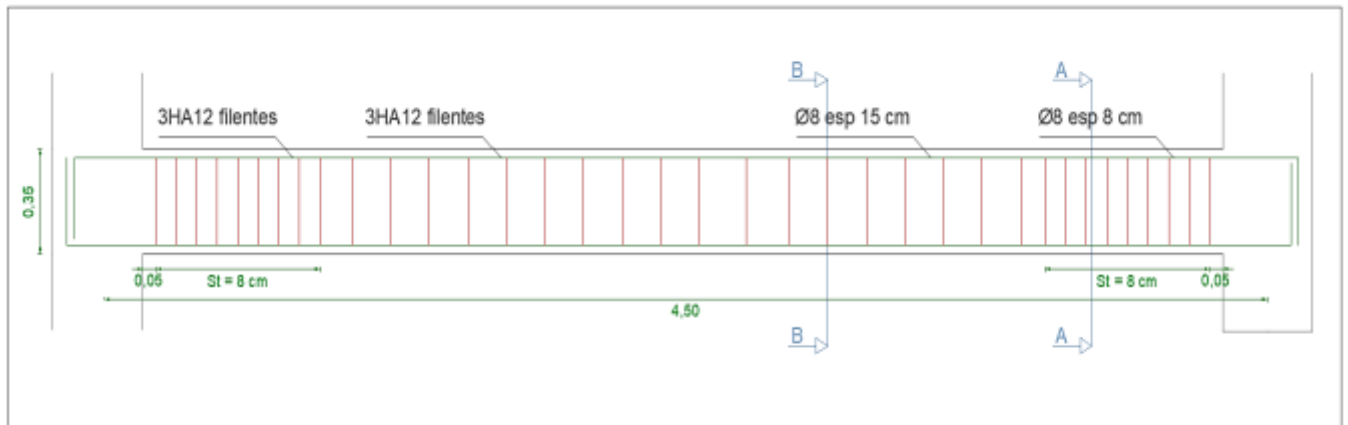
« Schéma du ferrailage de la poutre palière »
